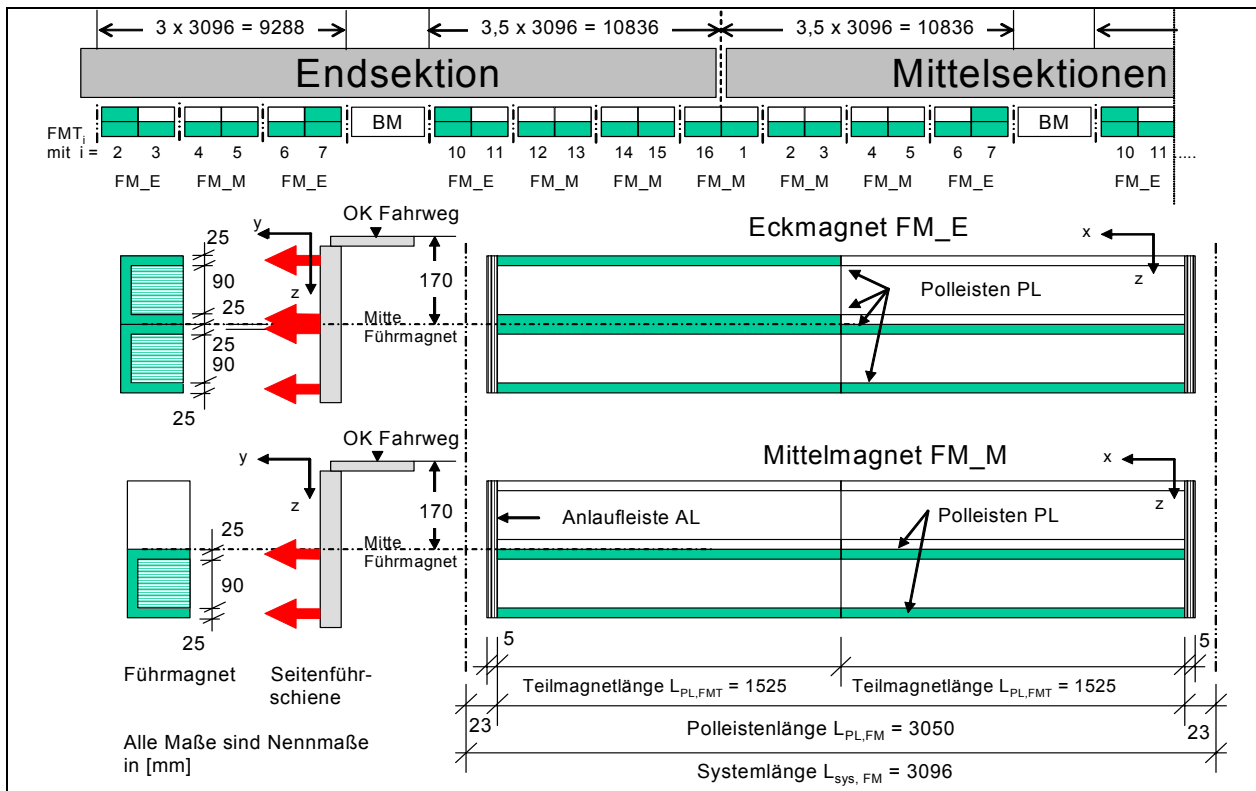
Typische Geometrie der Einwirkungen Führungsmagnet - Seitenführschiene
